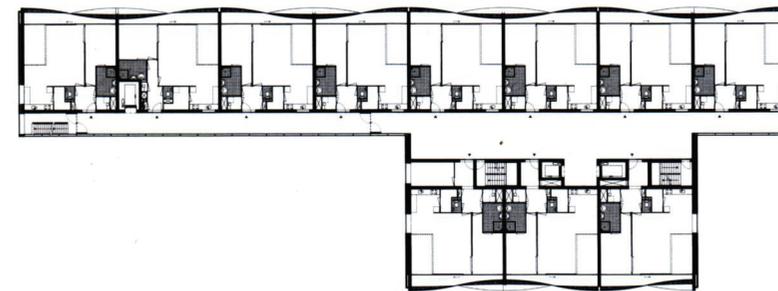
Grundriss 5. Obergeschoss M 1:1250
